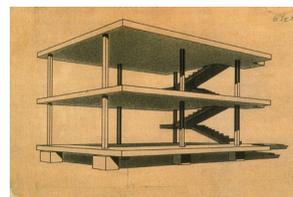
Schema strutturale a pianta libera, con solai, scale e pilastri in calcestruzzo armato, applicato al progetto delle Case Domino, 1914-1915
